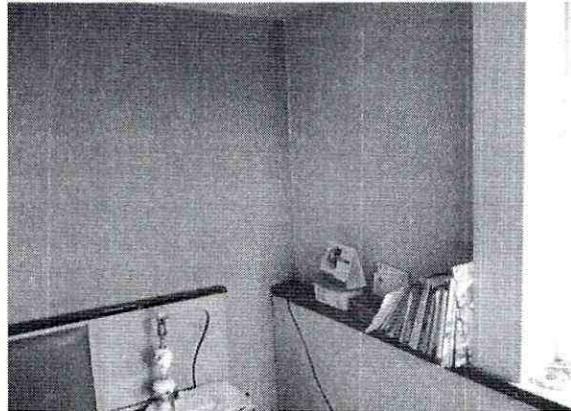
Estado actual de los muros interiores en el tercer piso de la edificación.
